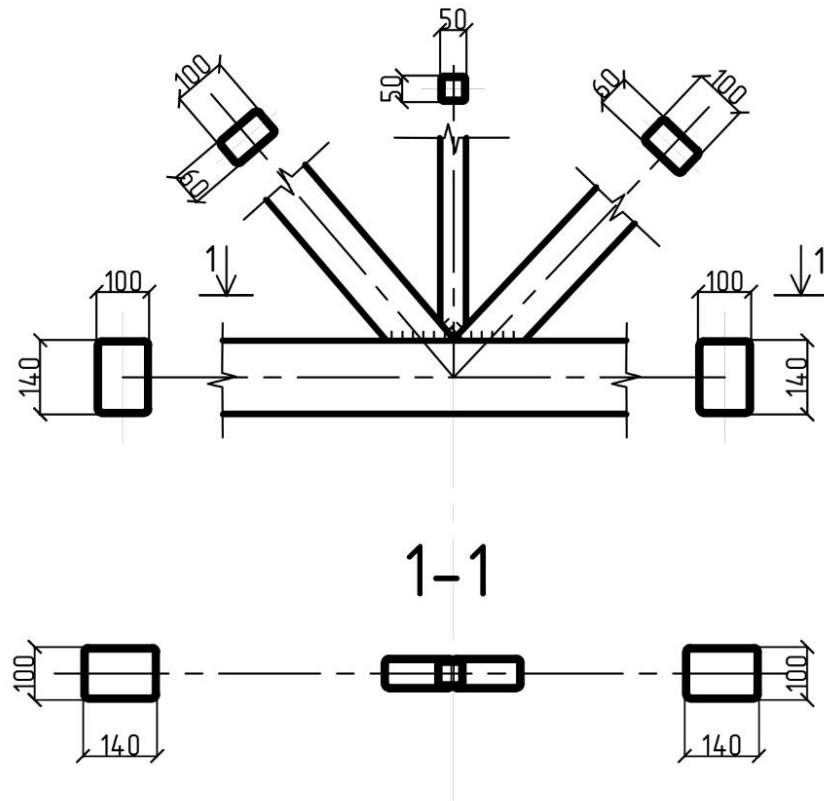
Узел 4-4. Узел соединения нижнего пояса с раскосом металлической фермы.
